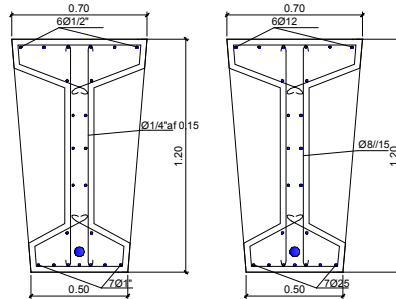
Armadura na secção de meio vão de uma longarina (ponte sobre o rio Save).
